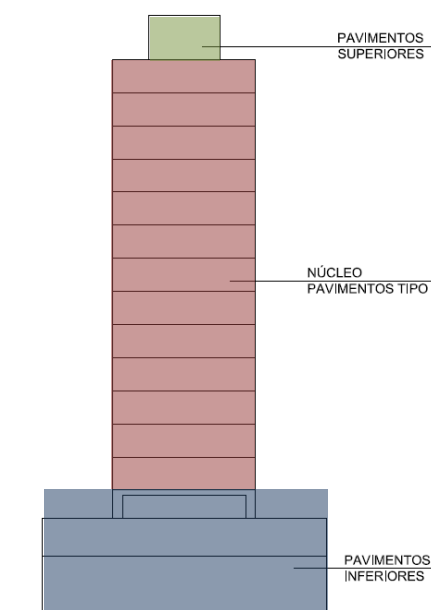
Setorização da edificação a partir da configuração/tipo de uso dos pavimentos
